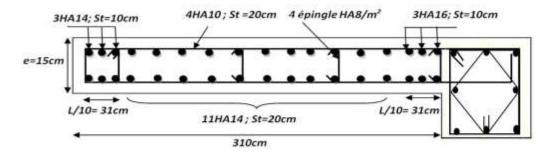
Schéma de ferraillage d'un voile V_{xd} (RDC)=3.10m
